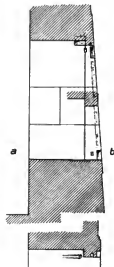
Schnitt durch das westliche Fenster im Westturm, erstes Obergeschoß, darunter Querschnitt a b.
